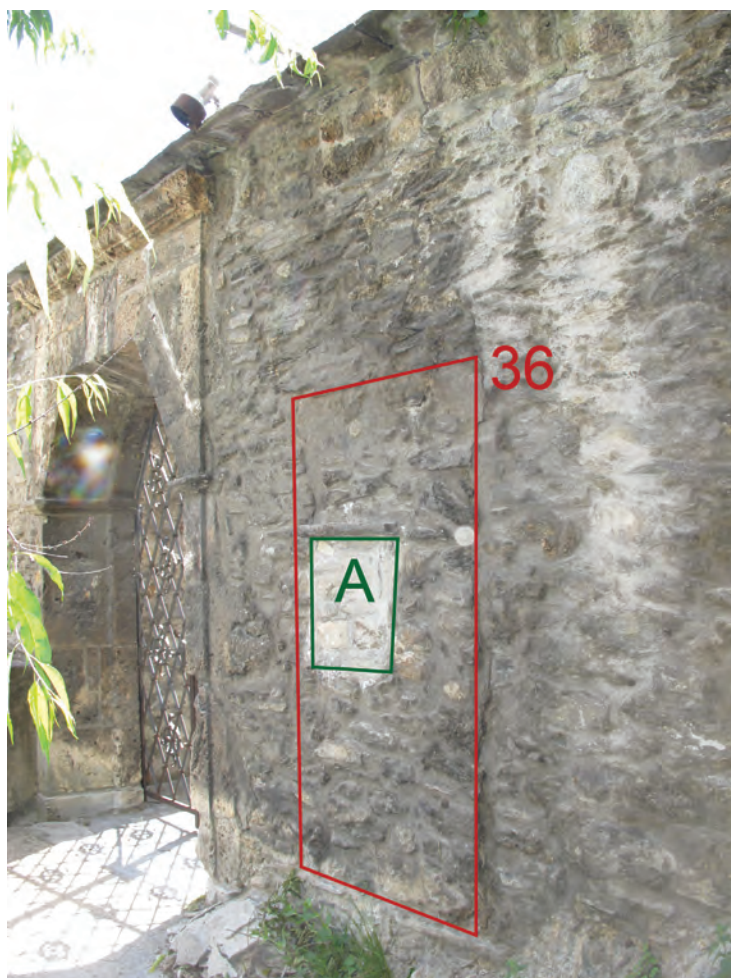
Sion, Majorie. Galerie d'accès. Façade orientale, vue vers le sud-ouest. L'ancienne porte (36) bouchée du petit bâtiment. A : niche aménagée dans le bouchon et bouchée à son tour.
